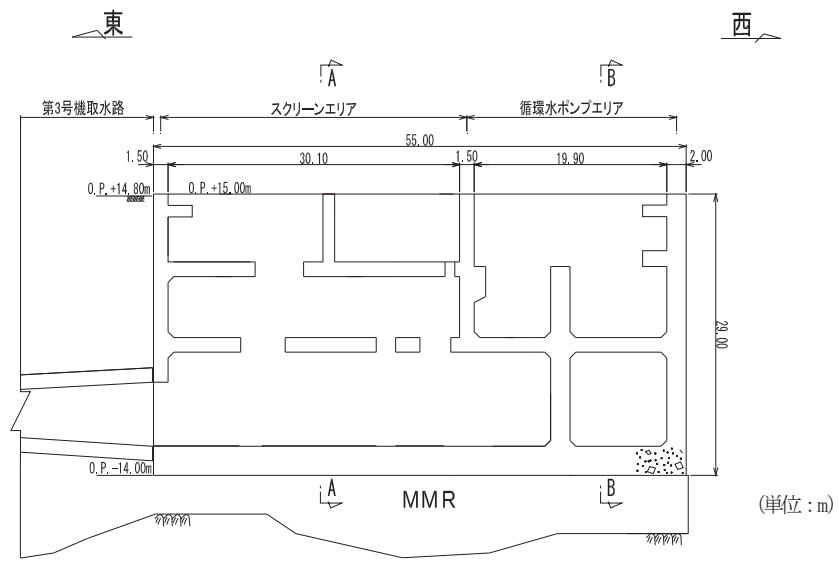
第3号機海水ポンプ室縦断図 (C-C)
